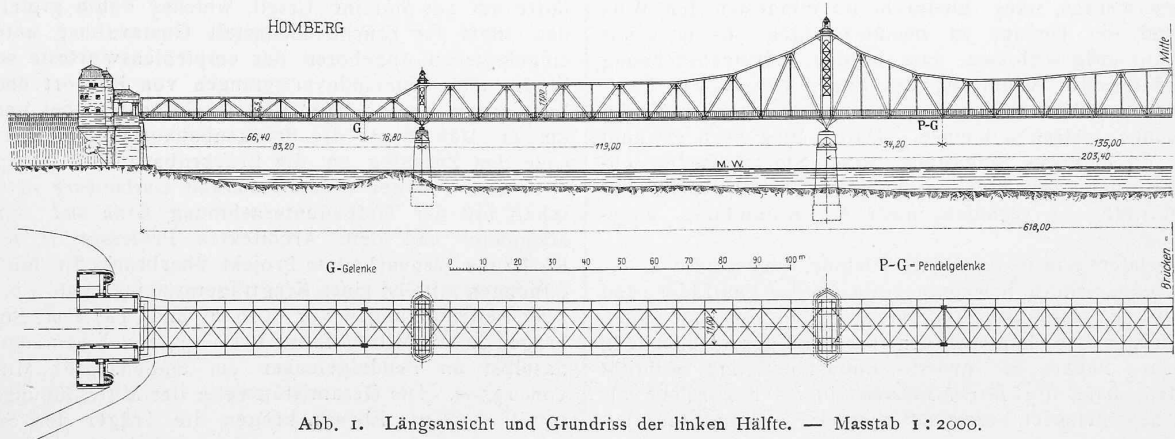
Längsansicht und Grundriss der linken Hälfte. — Masstab 1 : 2000.
